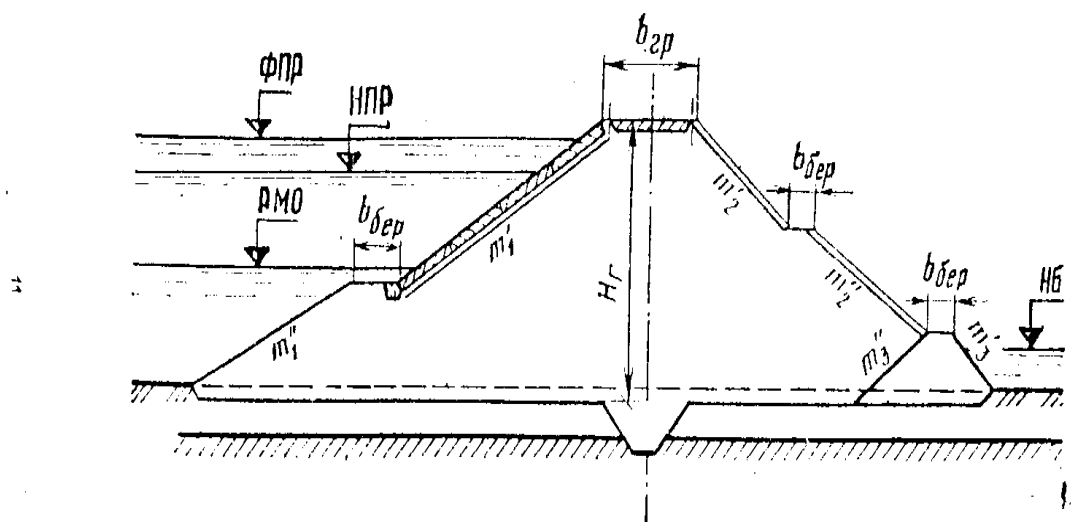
Поперечний переріз ґрунтової греблі
